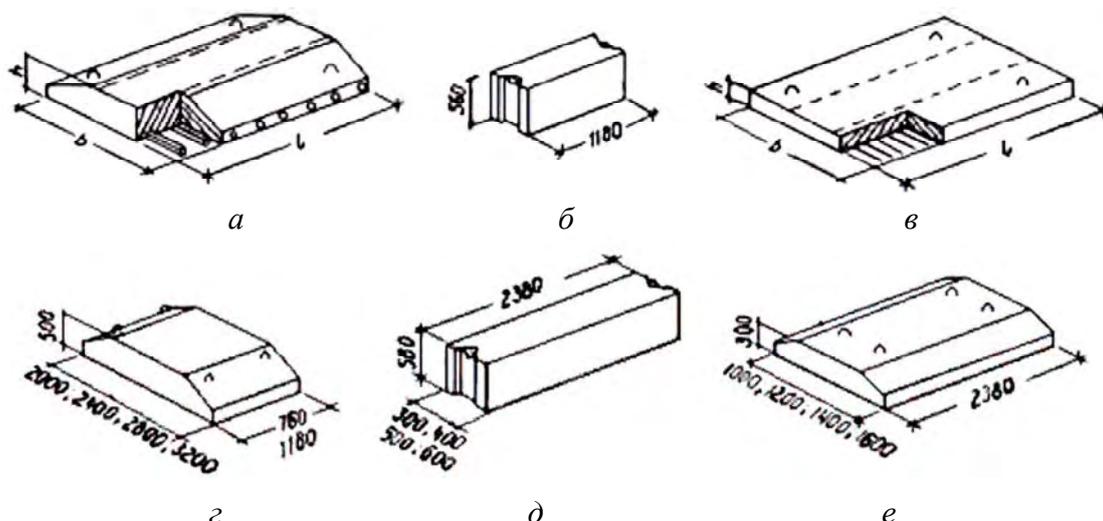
Сборные железобетонные фундаментные подушки и бетонные блоки: а, в, е — блок-подушка с предварительно напряженной арматурой; б — укороченный стеновой блок; г — укороченная фундаментная подушка; д — стеновой фундаментный блок
